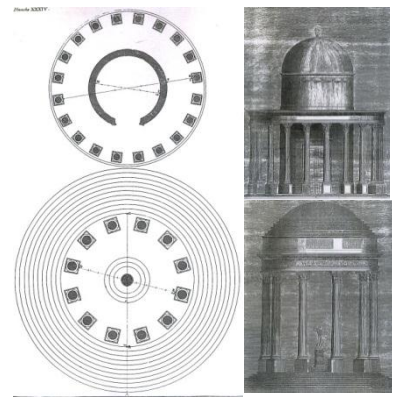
| Planta e alçado de um templo Períptero, em cima, e Monóptero, em baixo
